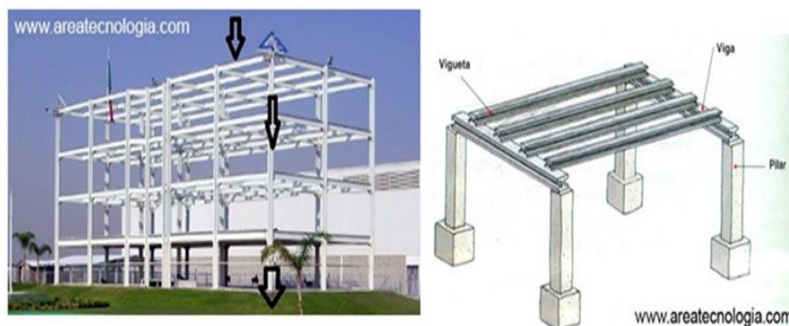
Estructura Metálica. Fuente: [Tecnología](#) (2017)
